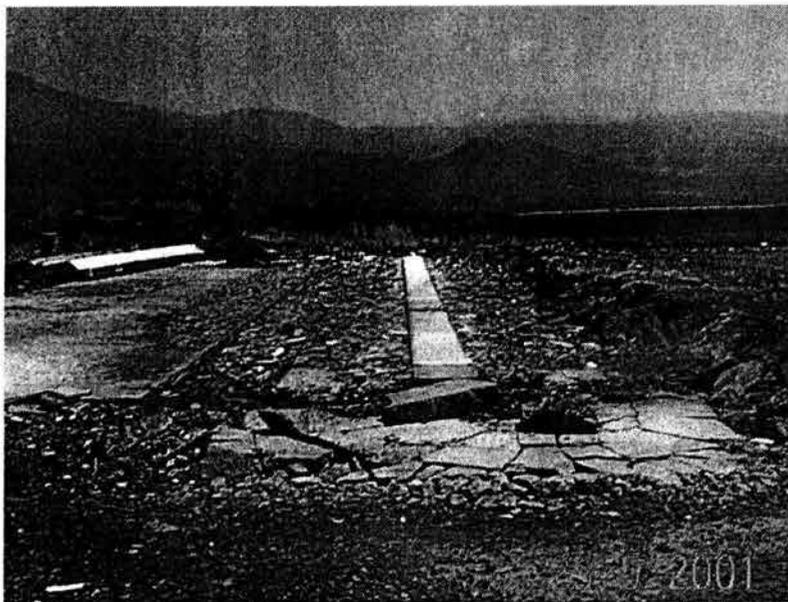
plataforma de concreto para trabe, Foto tomada en planta ya desmontada
